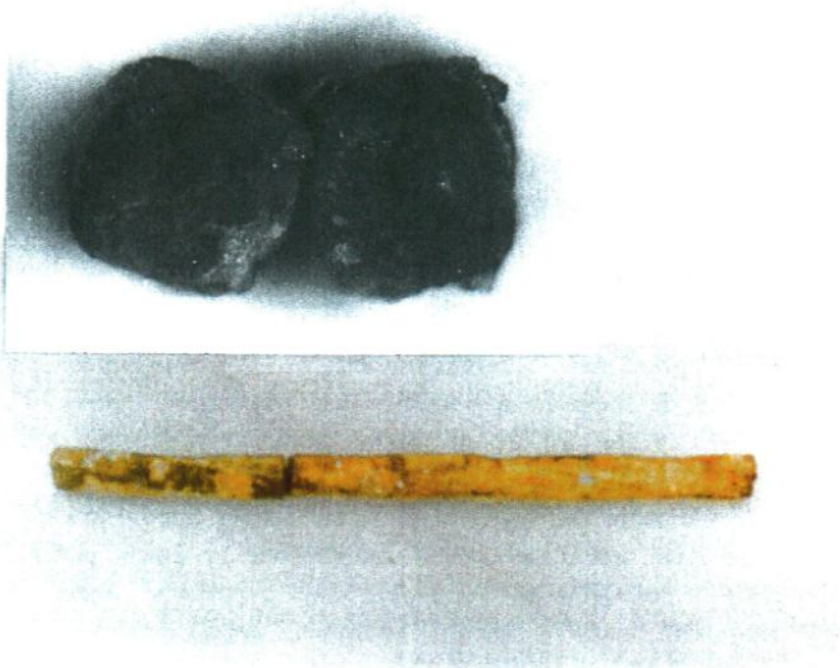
Armătură fisurată prin acțiunea atomului de hidrogen (cu detaliu în secțiune)
